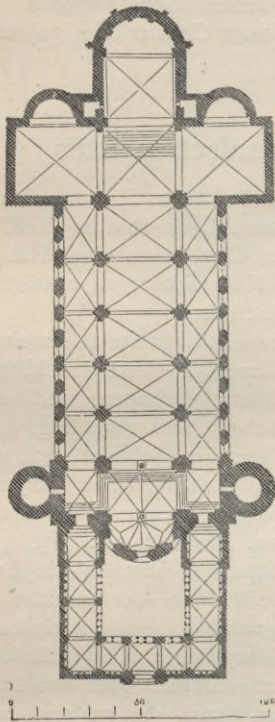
Grundriss der Abteikirche zu Laach.
